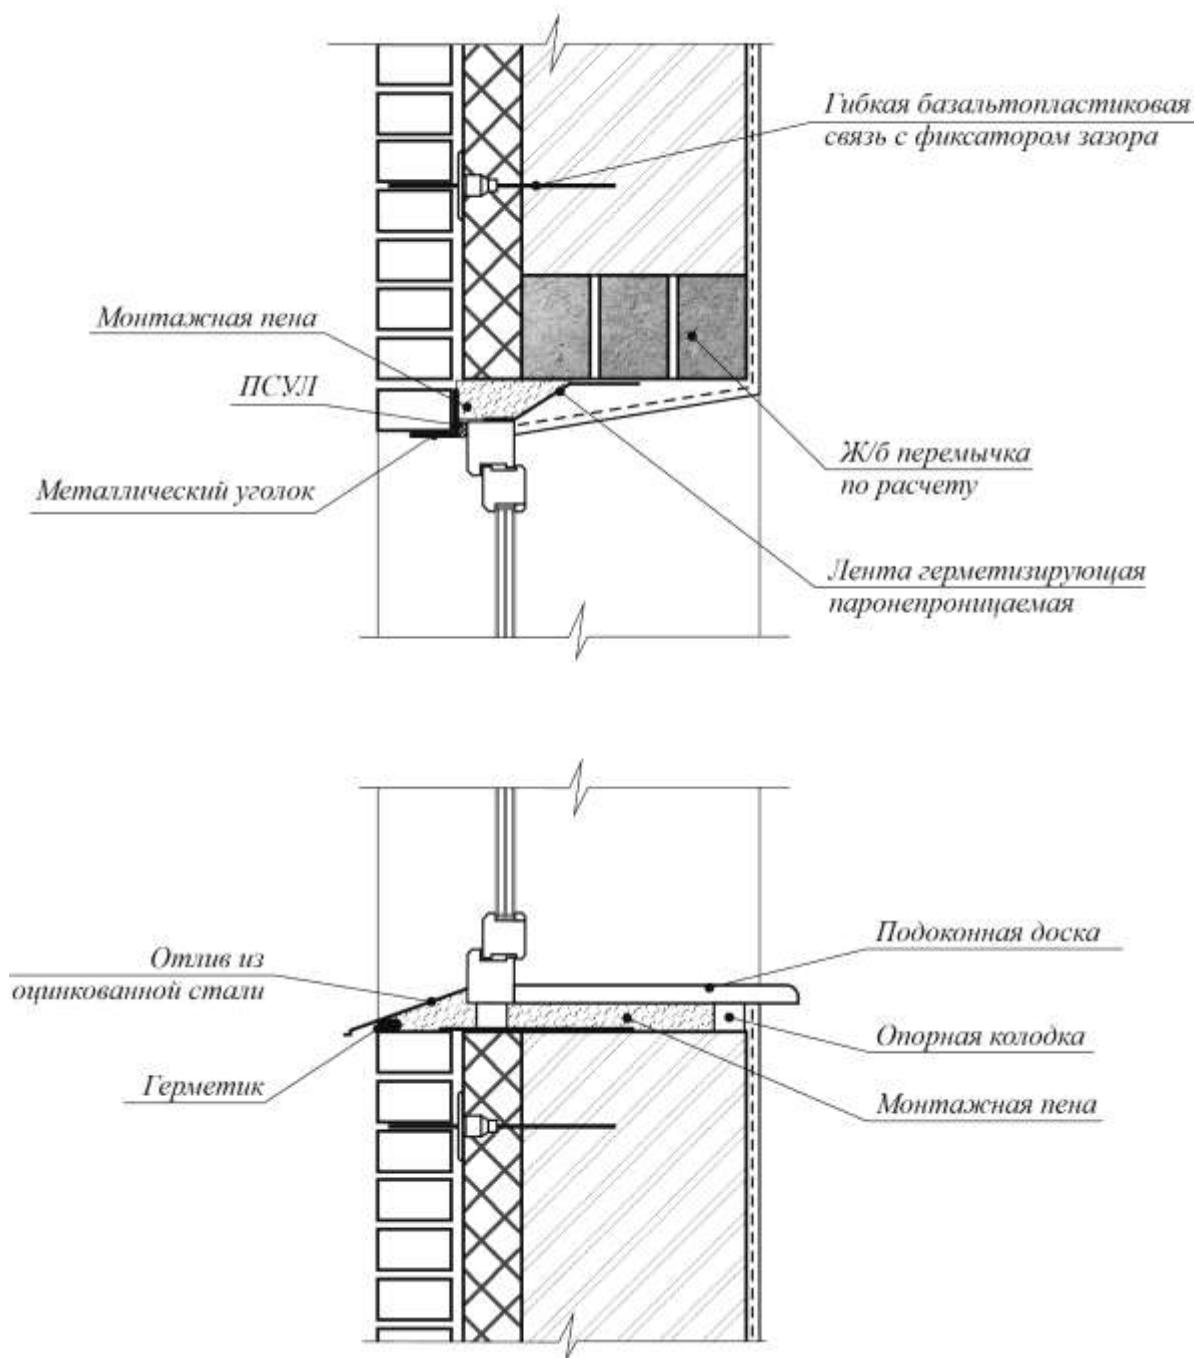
Узлы устройства оконного проема в наружной стене из трехслойной кладки
